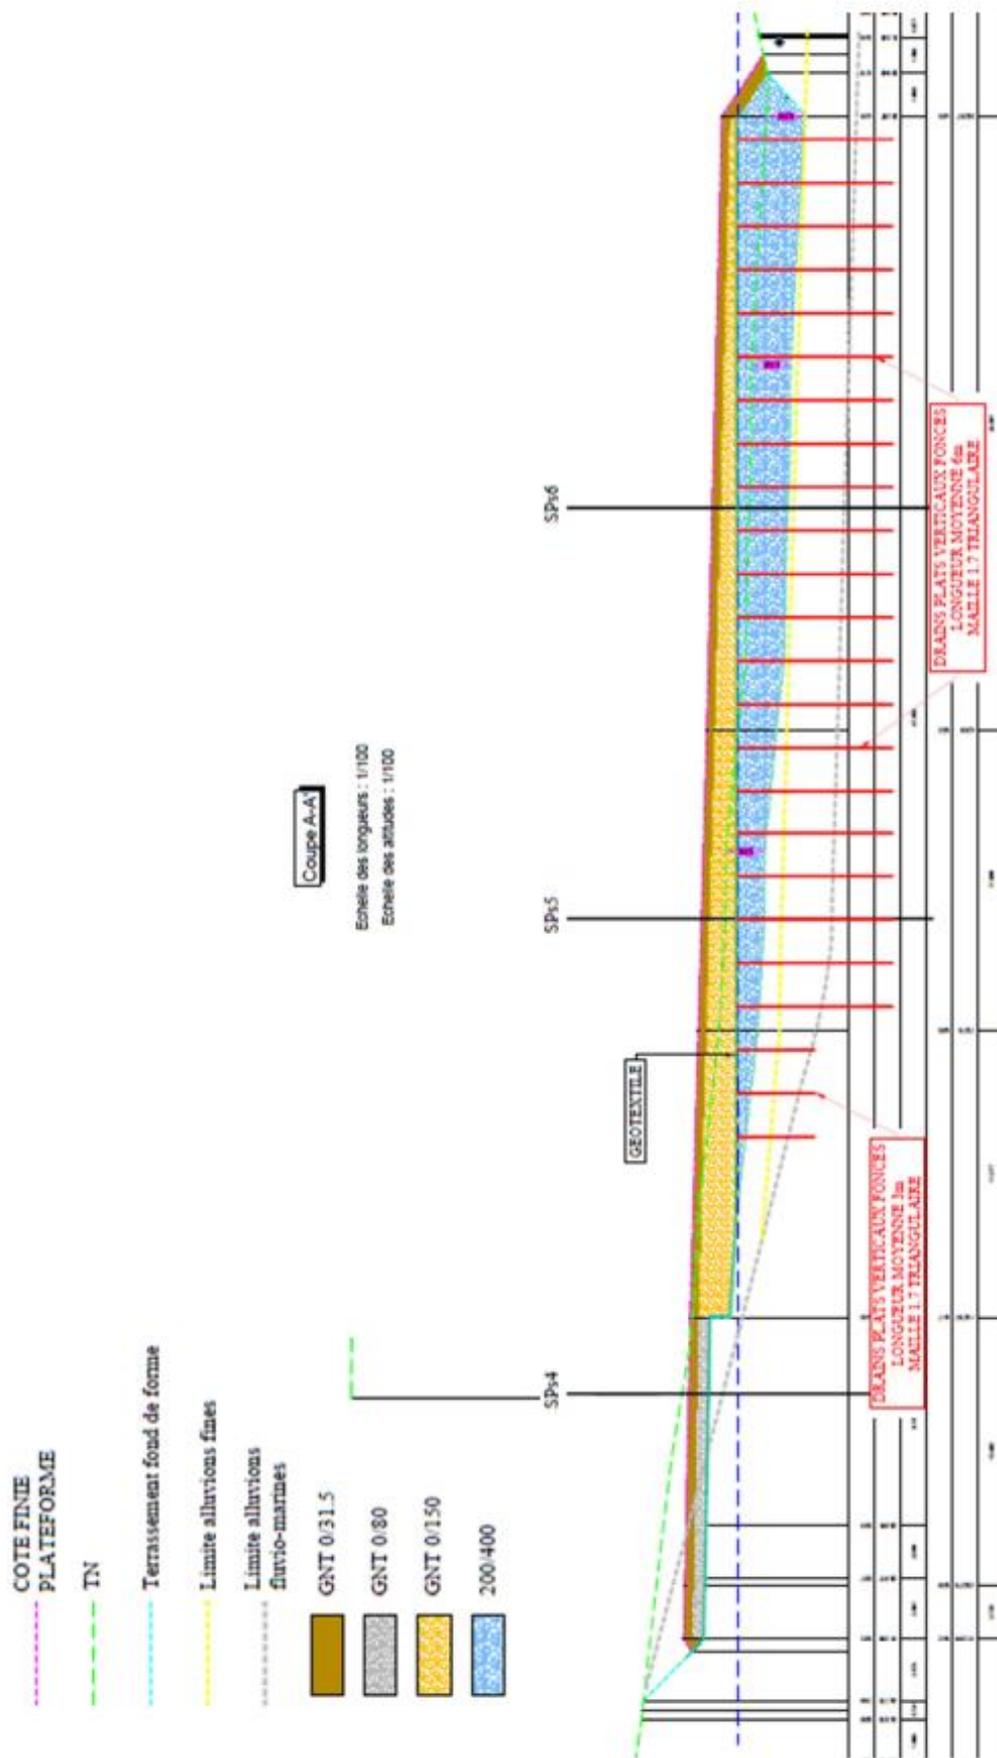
Coupe AA' matérialisant les remblais constituant la plateforme (200/400, GNT 0/150 et GNT 0/31.5)
